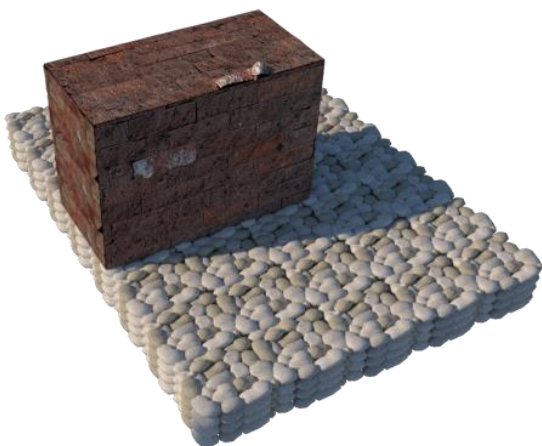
Modelo 3D, cimentación de piedra bola y muro de tepetate
